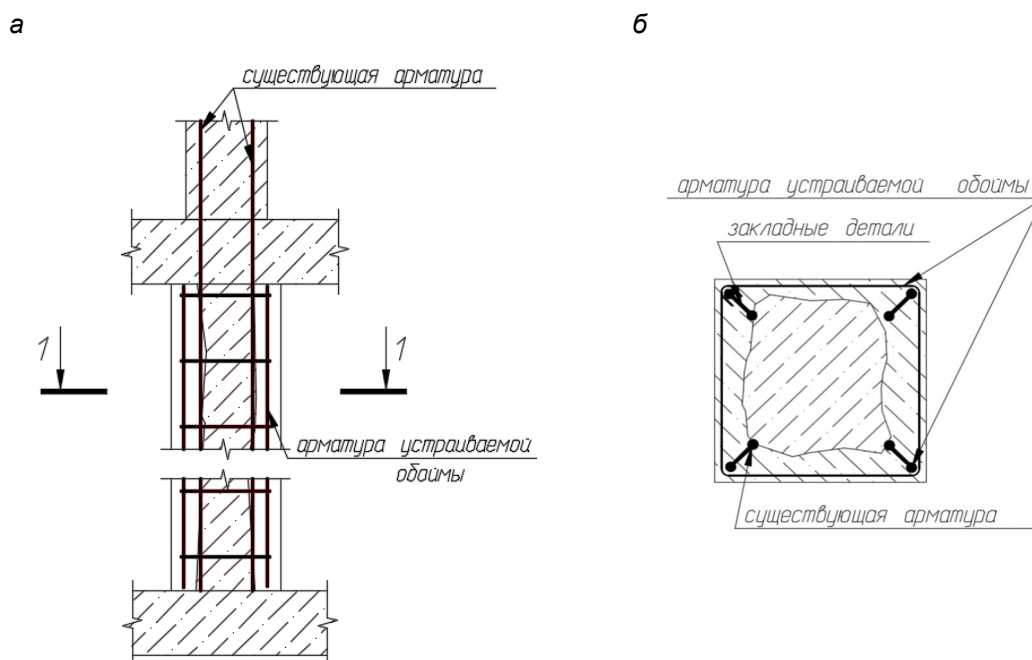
Усиление колонны железобетонной обоймой («рубашкой»):
